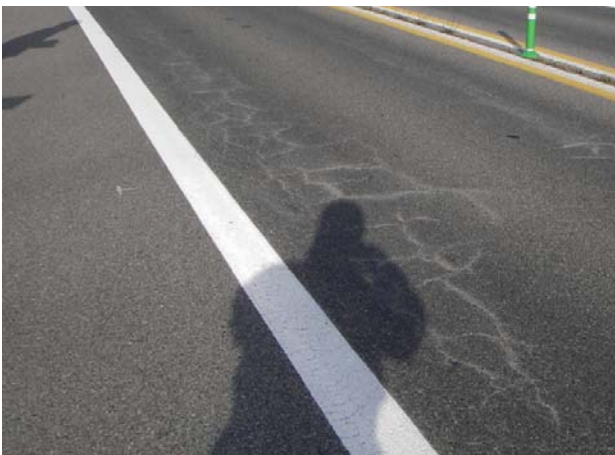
因島北IC区間補修前（ひび割れ状況）
